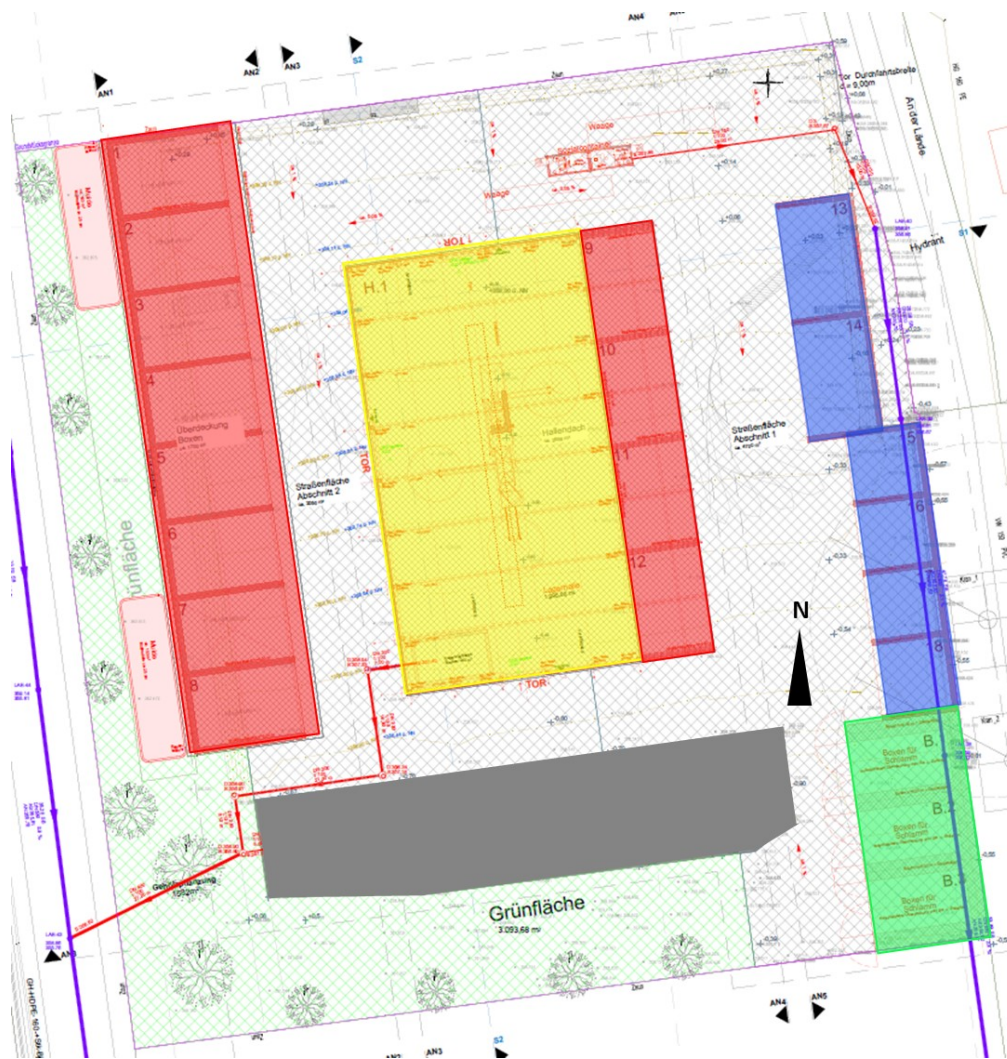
Lageplan der geplanten Dichtfläche mit Lagerboxen, Lagerhalle und Regenrückhaltebecken
